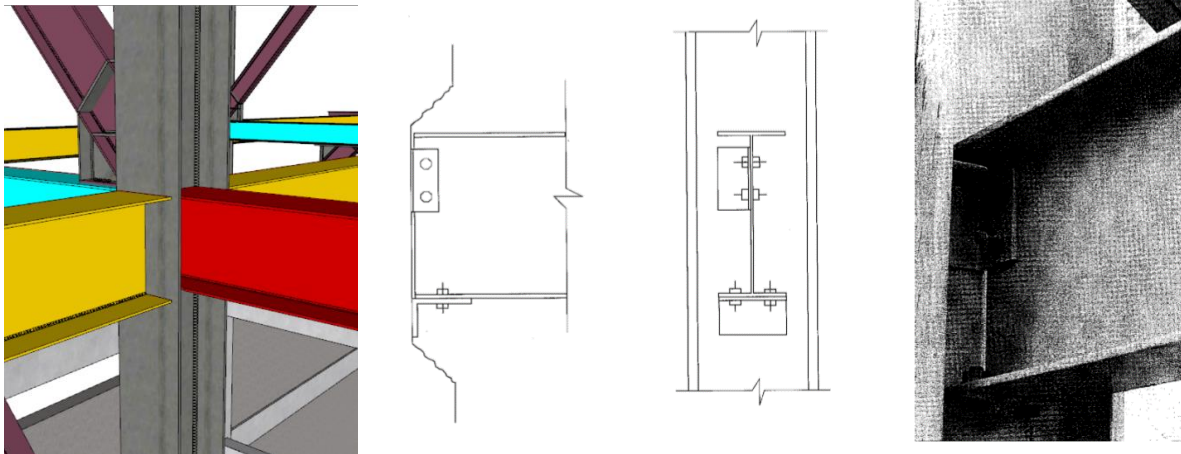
Viga roja: 0.40 m. de peralte. Conexión Viga-Columna: Ángulo de asiento. Fuente: Elaboración propia
